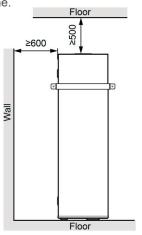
Schema di installazione del serbatoio dell'acqua (Unità: mm)
